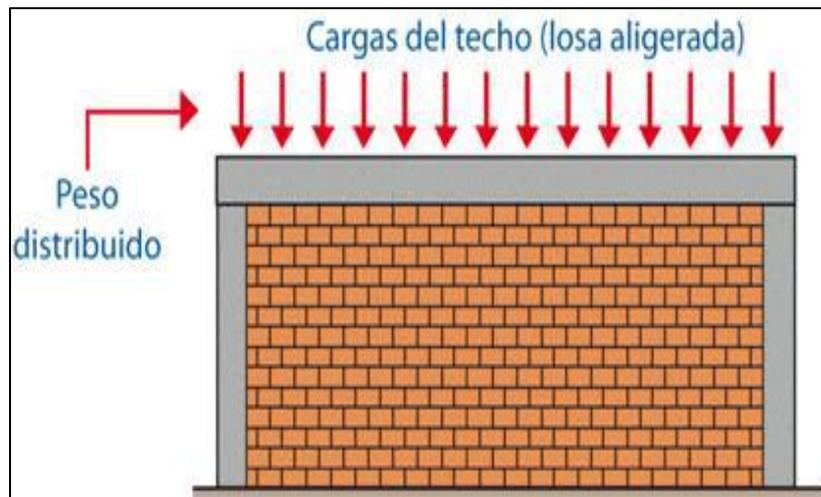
Detalle de Albañilería Confinada (Muro Portante)
